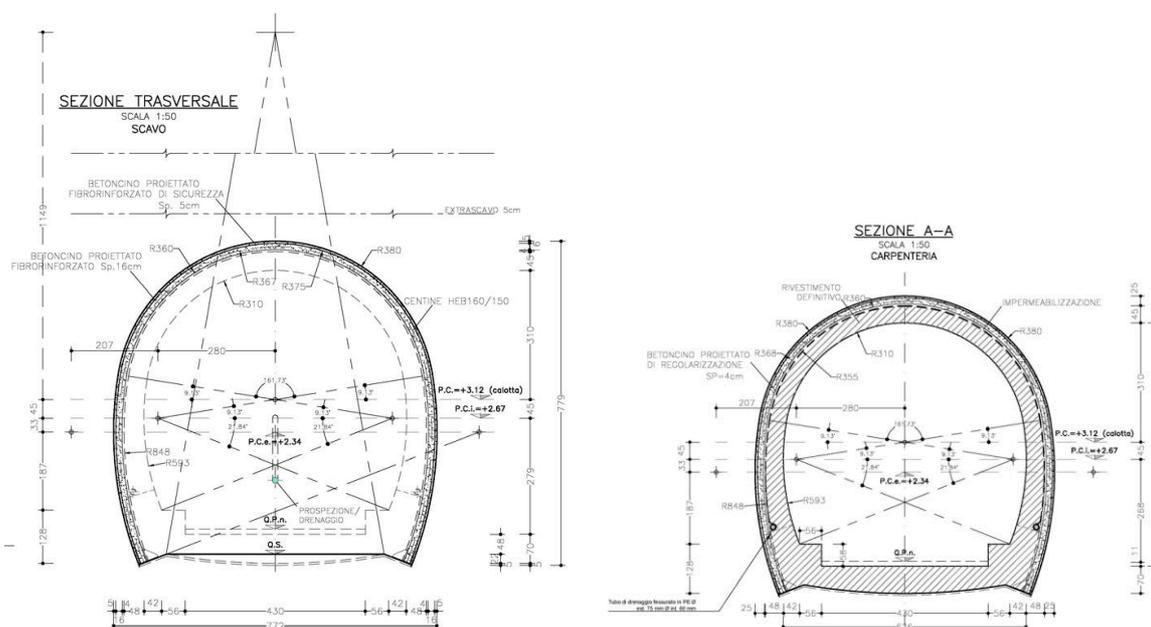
Sezione N-CE-A2 – Sezione di scavo (a sx) e Carpenteria (a dx).
